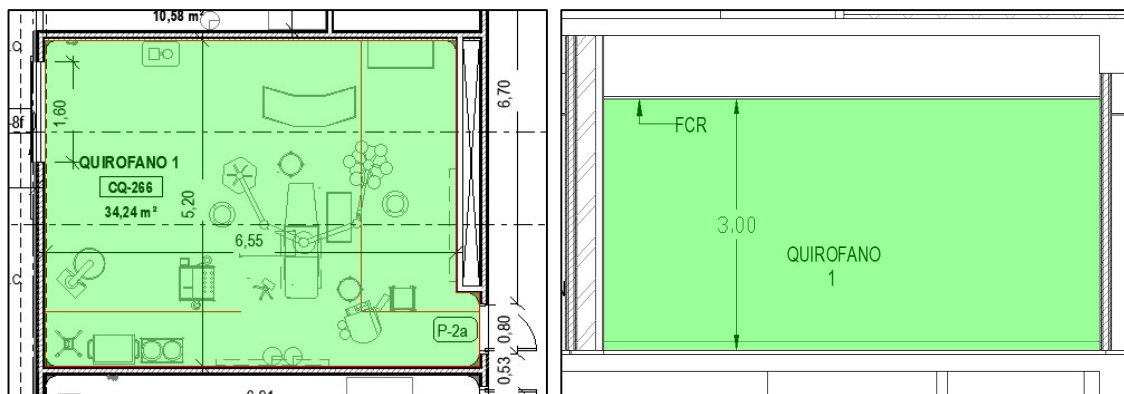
Vista de planta y corte de Quirófano N° 01.
